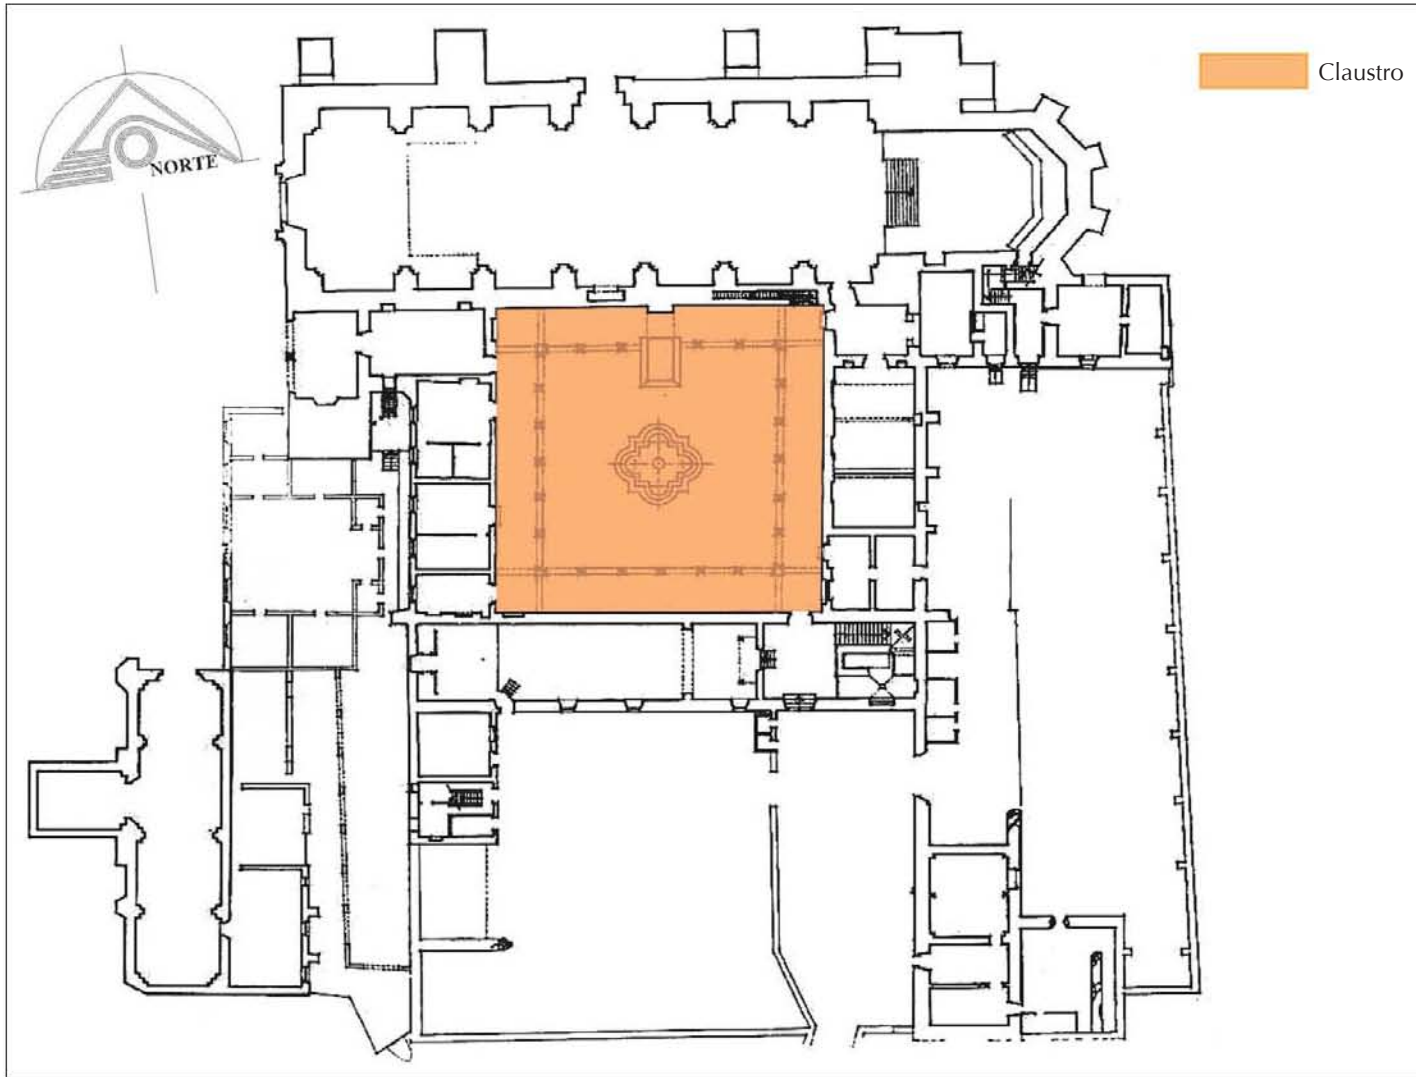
San Bernardino de Siena, claustro, planta baja. Fuente: Planoteca, CNMH-INAH. DGOSMPC, SDU, Sedue, director general del proyecto de restauración, septiembre de 1986: Sergio Saldívar Guerra.
